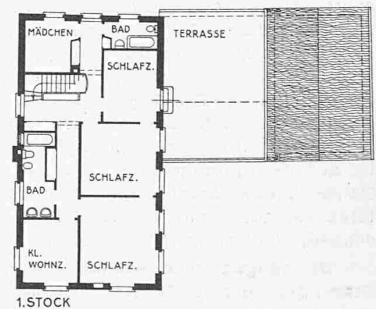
Grundrisse, Masstab 1 : 400
